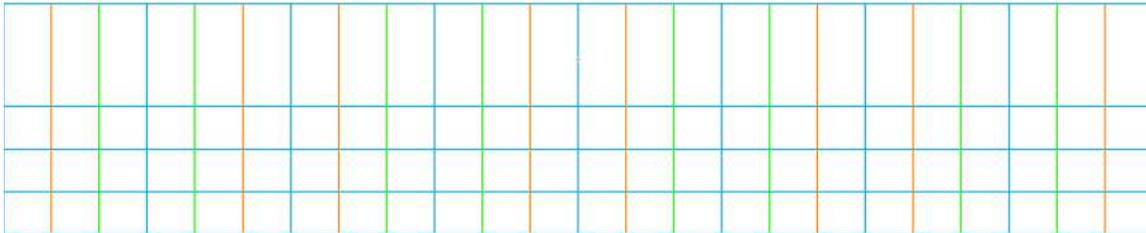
Struttura di sovrapposizione dei singoli prospetti per lo sviluppo lineare del prospetto complessivo.
